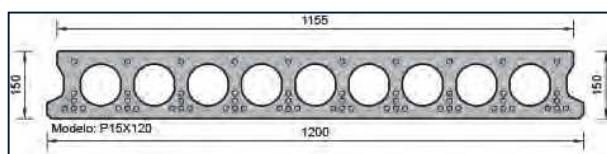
Detalle de las dimensiones de la placa alveolar considerada.
